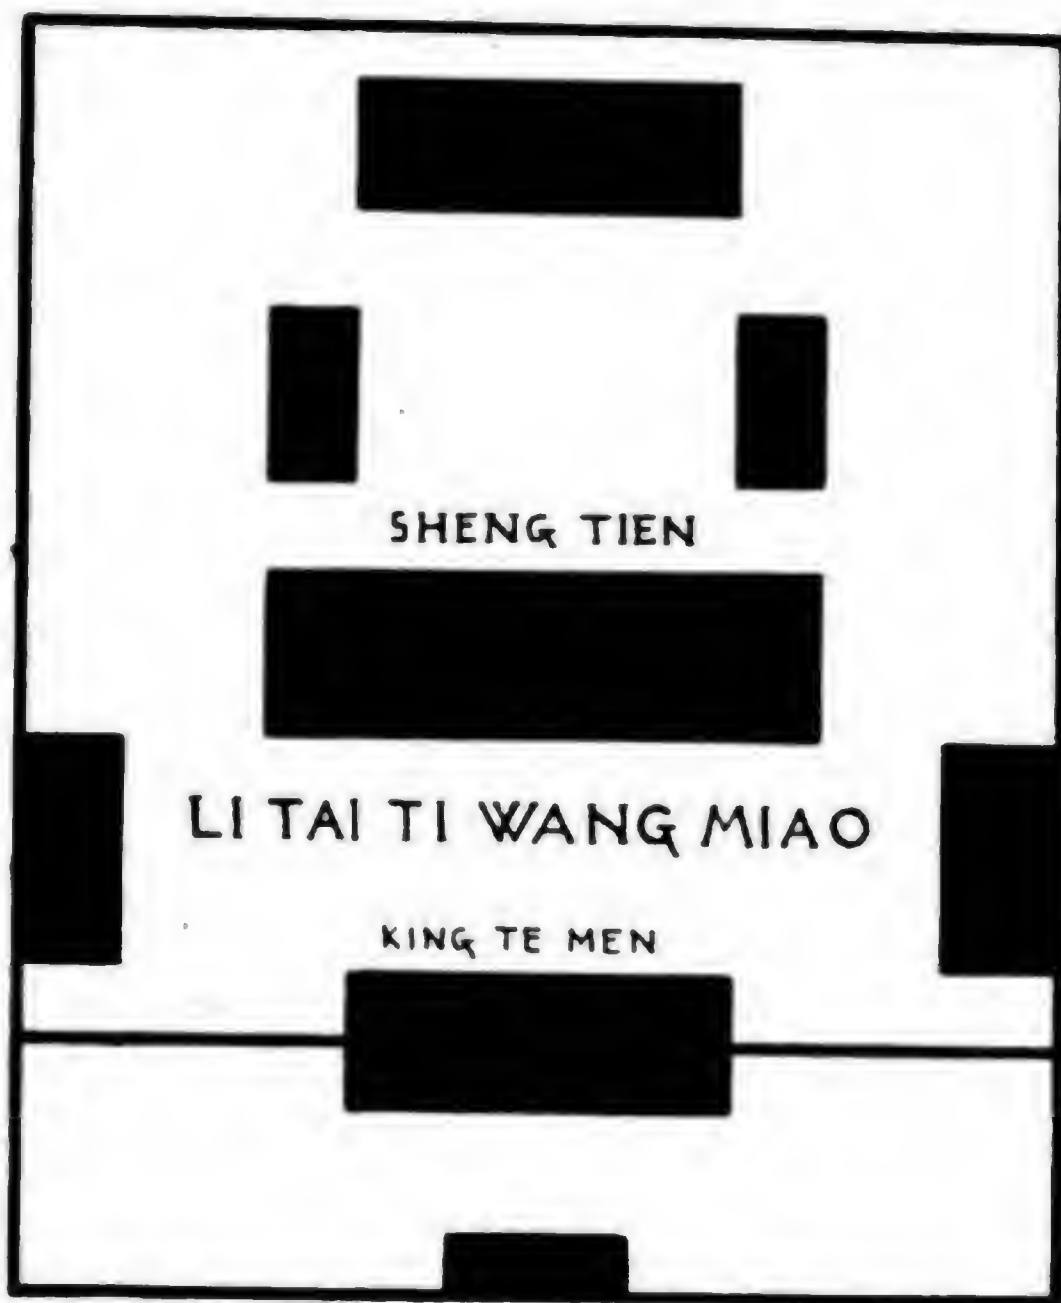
PLAN DU LI TAI TI WANG MIAO.
